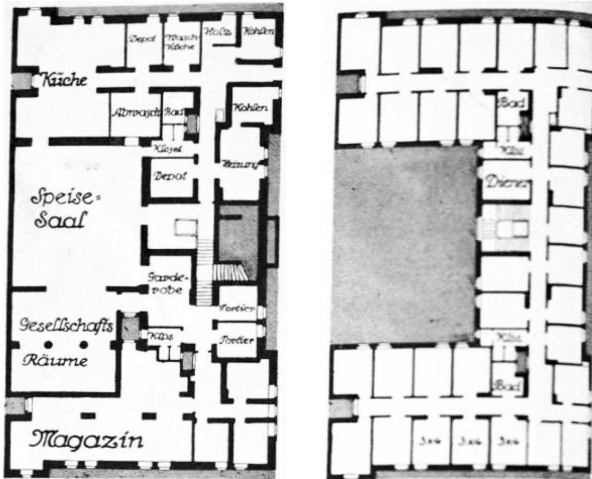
Heim für alleinstehende, beruflich tätige Frauen, 1190 Wien, Peter Jordan Strasse 32, 1911, Grundrisse Erdgeschoss und Obergeschosse. (Quelle: Das zweite Heim für alleinstehende erwerbende Frauen der Gemeinnützigen Bau und Wohnungs-Genossenschaft "Heimhof", Verlag „Heimhof“, 1914, S. 6)
